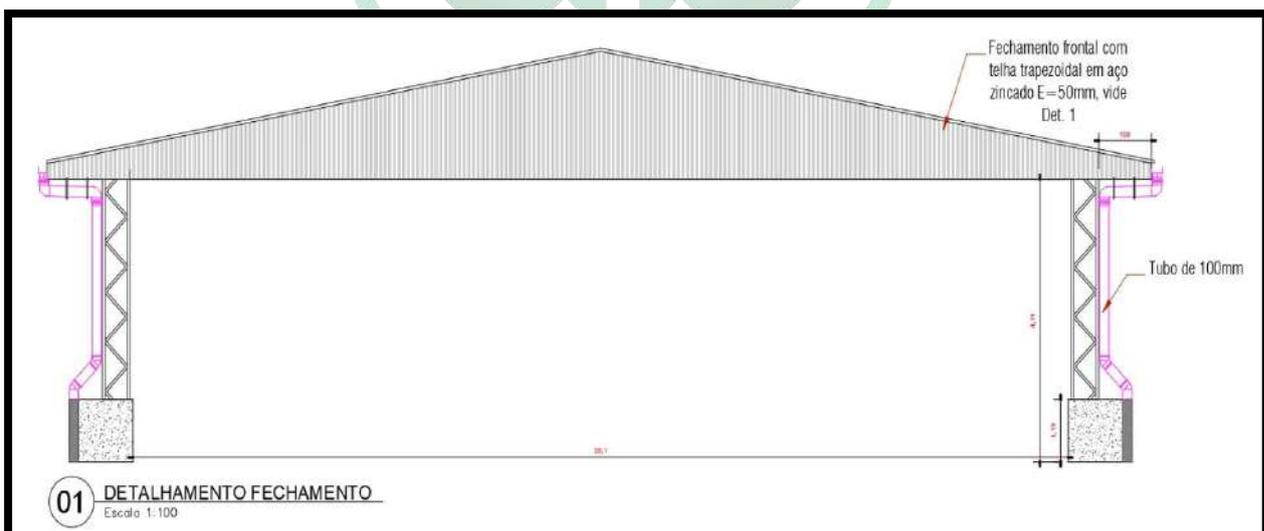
Fechamento lateral com telha trapezoidal de zinco esp: 50mm a ser executado.
